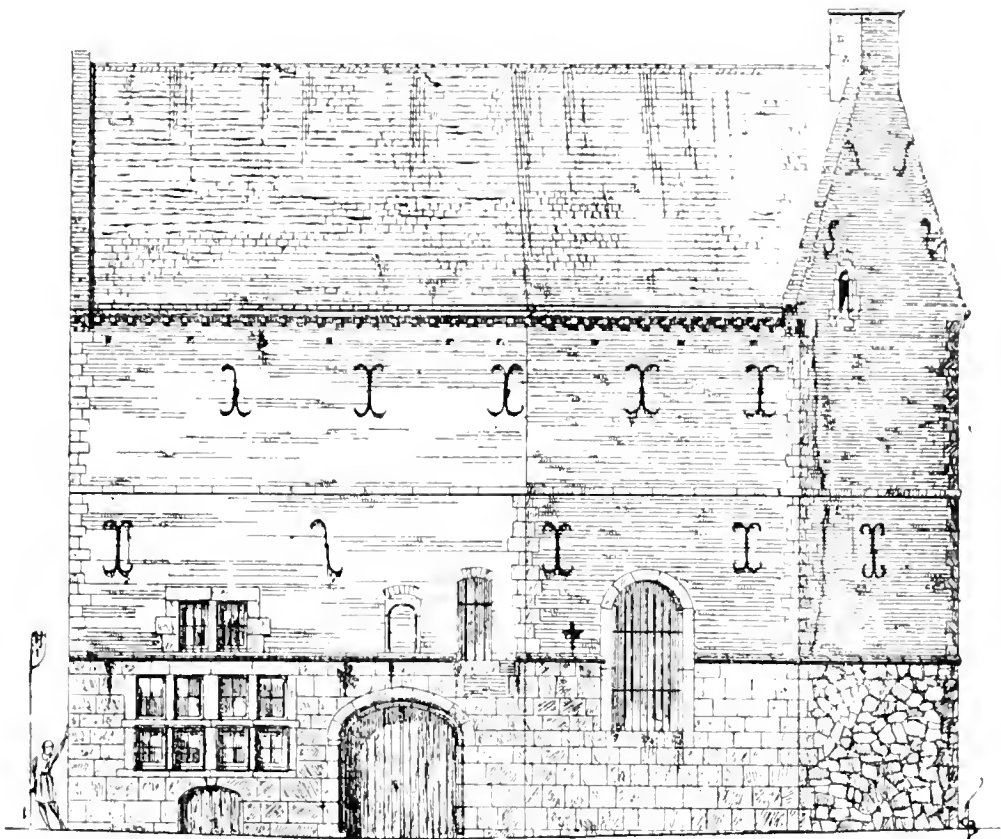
Façade de la brasserie, rue du Pont-d'He.
